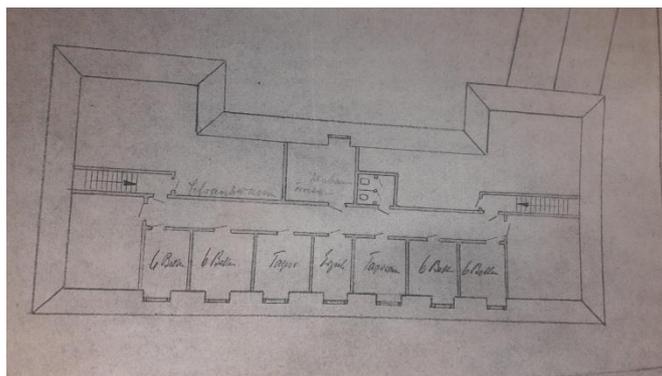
Bauplan Dachgeschoss „Rotes Haus“<sup>253</sup>
